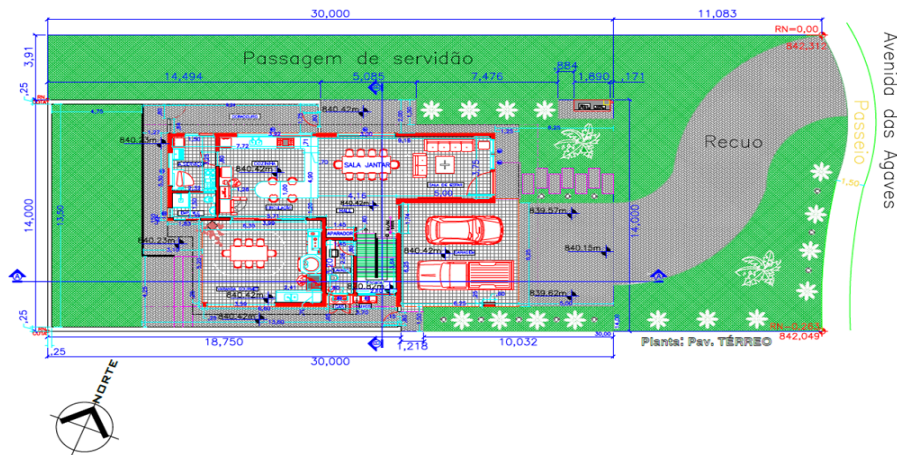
Imagem da planta do pavimento térreo do projeto arquitetônico
